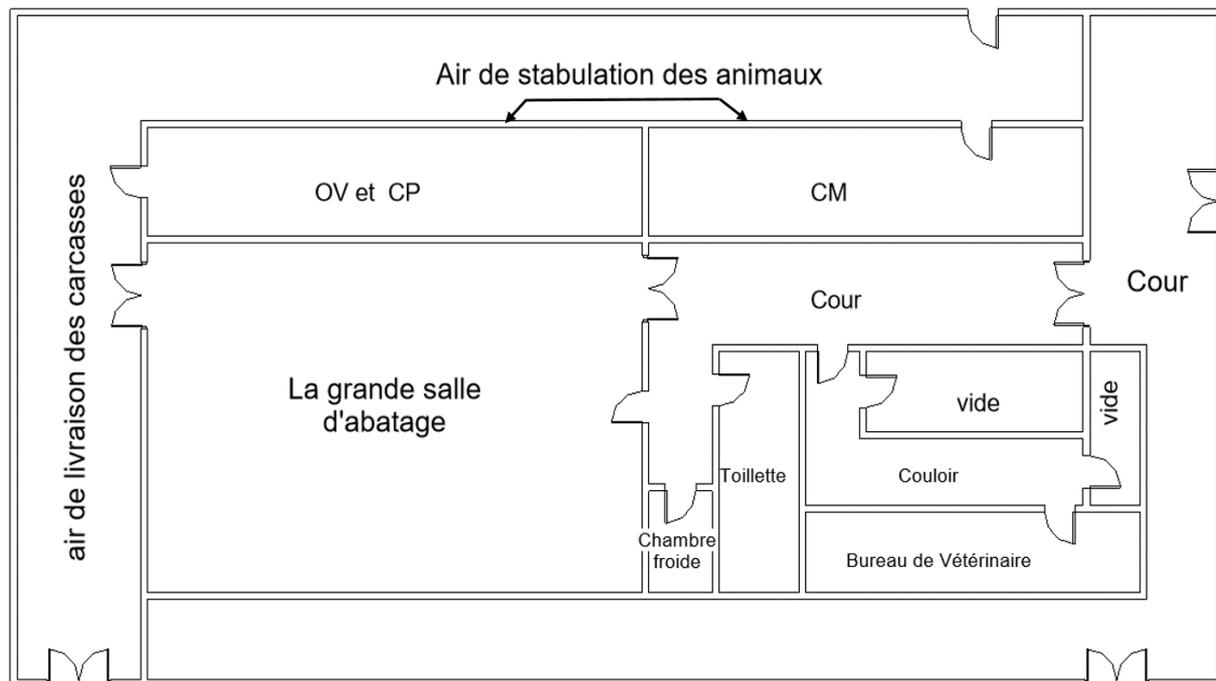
Plan de l'Abattoir d'Ain Salah (Travail personnel).
